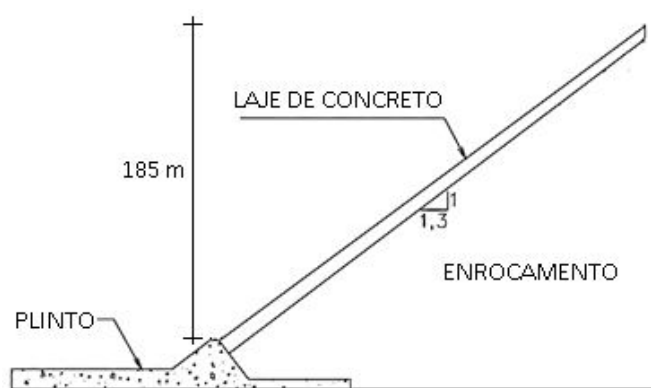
LAJE DA BARRAGEM DE BARRA GRANDE
